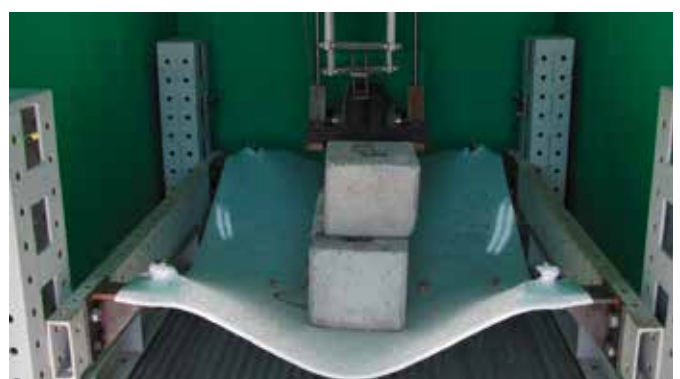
Laminado con Ionómero de 1,52 colapsó a 300 kg
